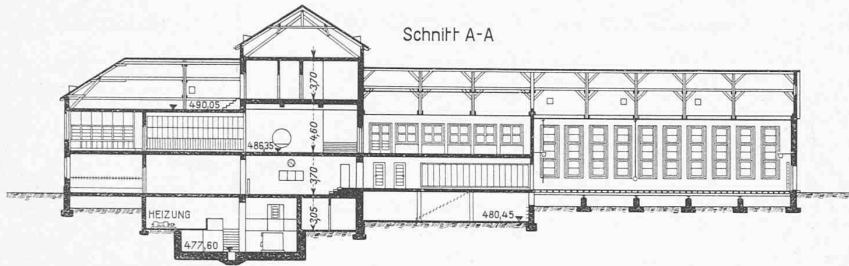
Schnitt A-A durch Hauptbau, gedeckte Spielterrasse und Turnhalle. — Masstab 1 : 600.
